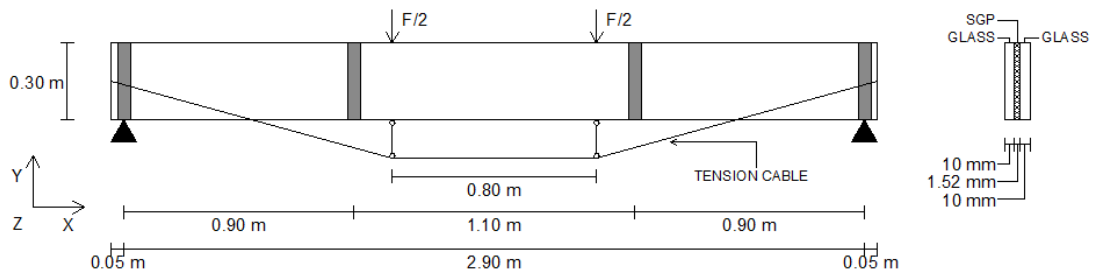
Geometria da viga e traçado do cabo de pré-esforço (retirado de (Jordão & Pinho, 2014)).
